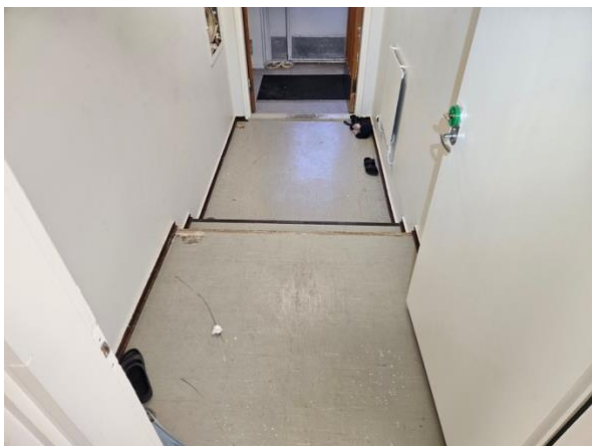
Näyte ASB 19, naisten pesuhuoneen lattian betonilaatan alapinnalla todettiin asbestikuituja. Avaus osui vanhan putken kohdalle, jonka eristettä oli todennäköisesti tarttunut betonilierion alapintaan.
